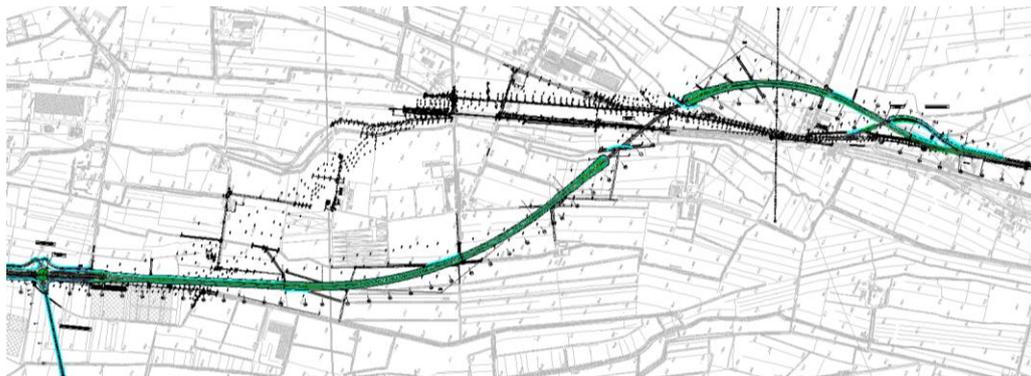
Tratto Svincolo di Vigasio - Svincolo di Buttapietra – Planimetria
